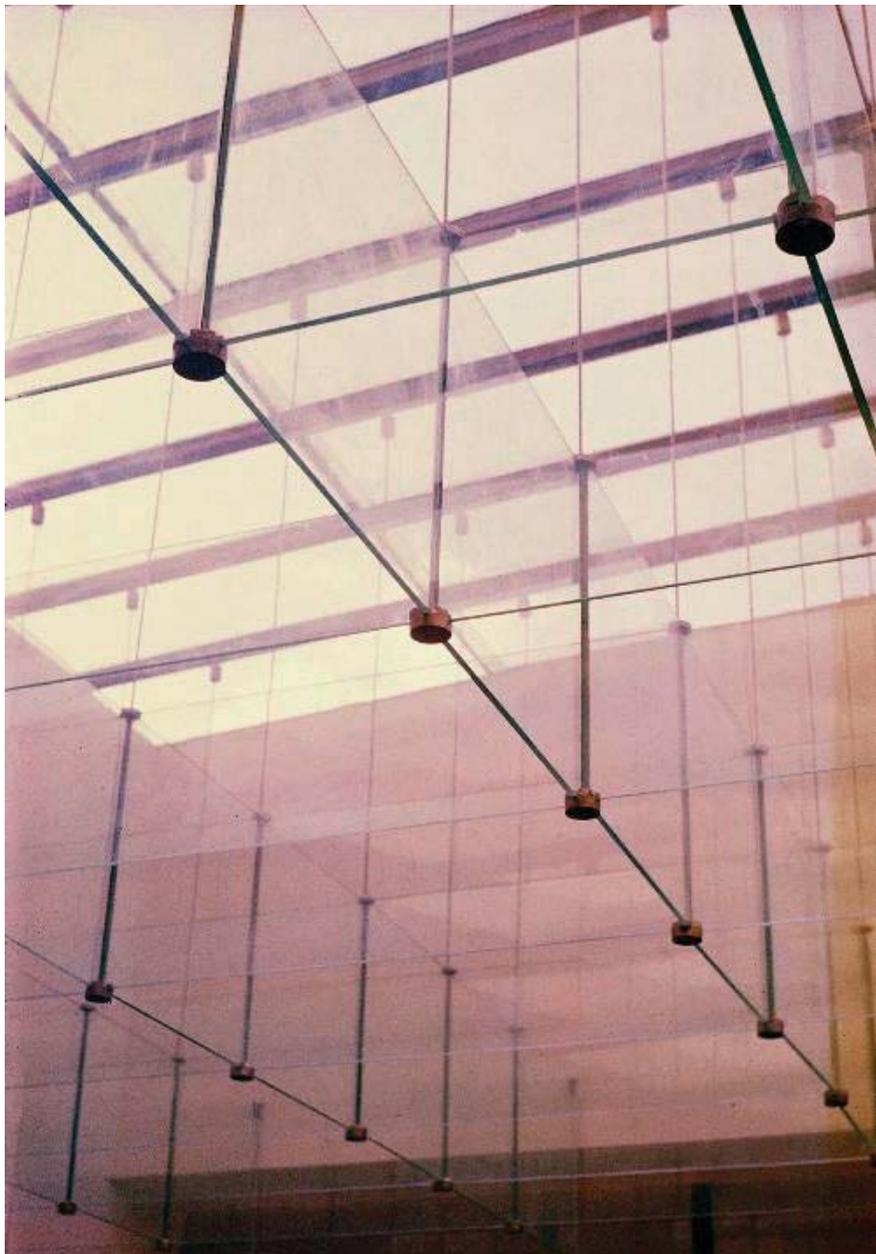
Lucernario de planta primera. Fundación Alejandro de la Sota.
